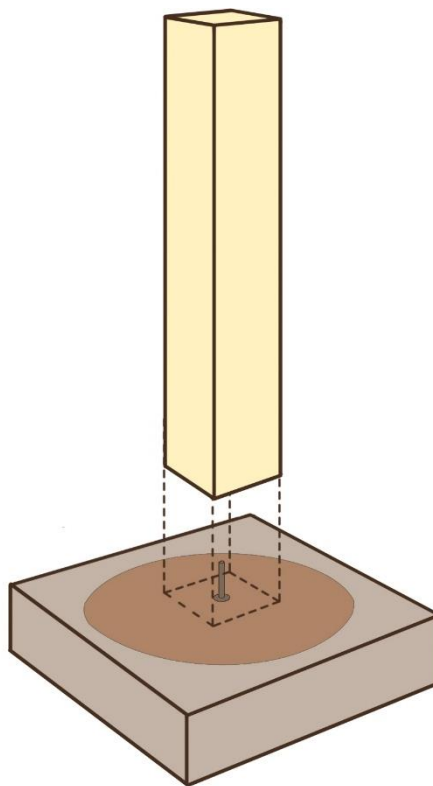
Dessin : Schéma illustrant l'articulation entre le poteau en bois et la base en pierre, réalisée grâce à un goujon d'ancrage en inox et à une couche de mortier de chaux assurant stabilité et protection contre les remontées d'humidité. Source : dessin de l'autrice.
